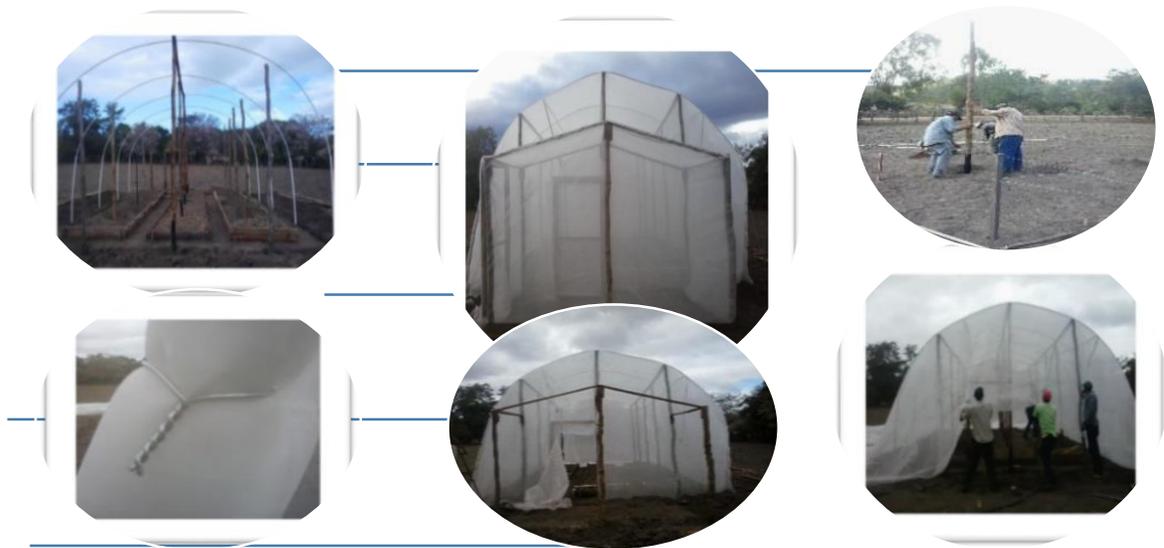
Construcción de las estructuras de casa malla-56 mts²
